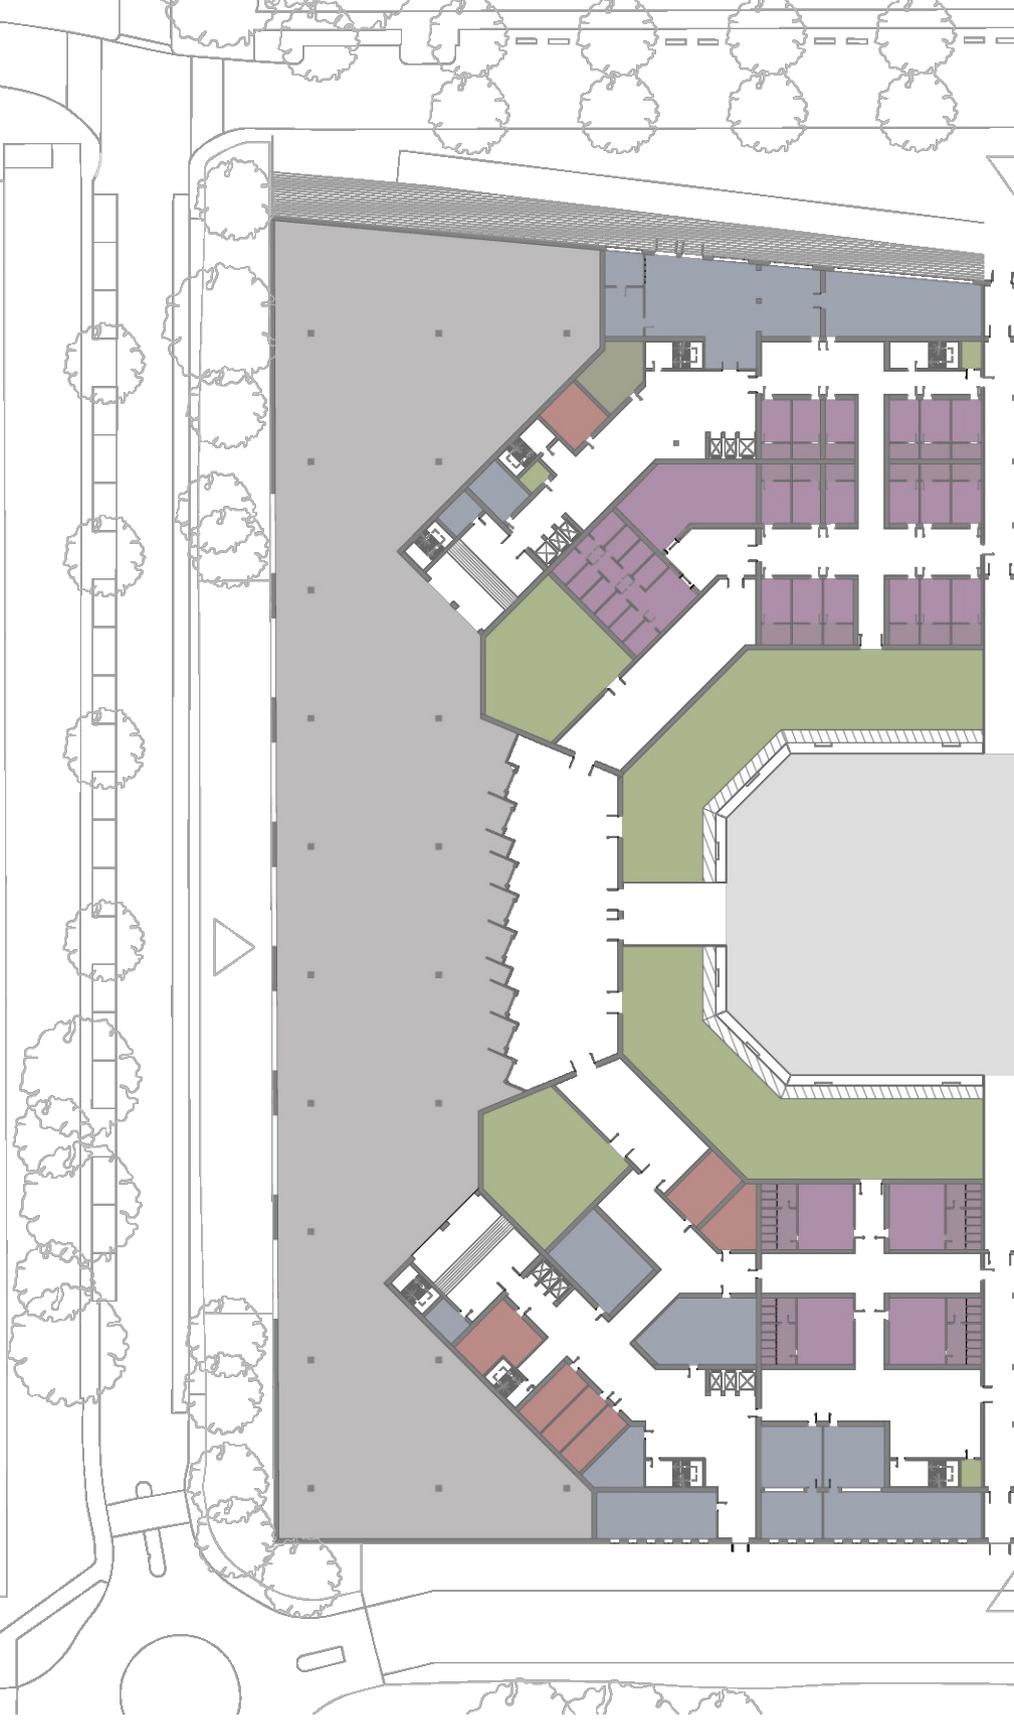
Grundriss EG Nutzungsverteilung
